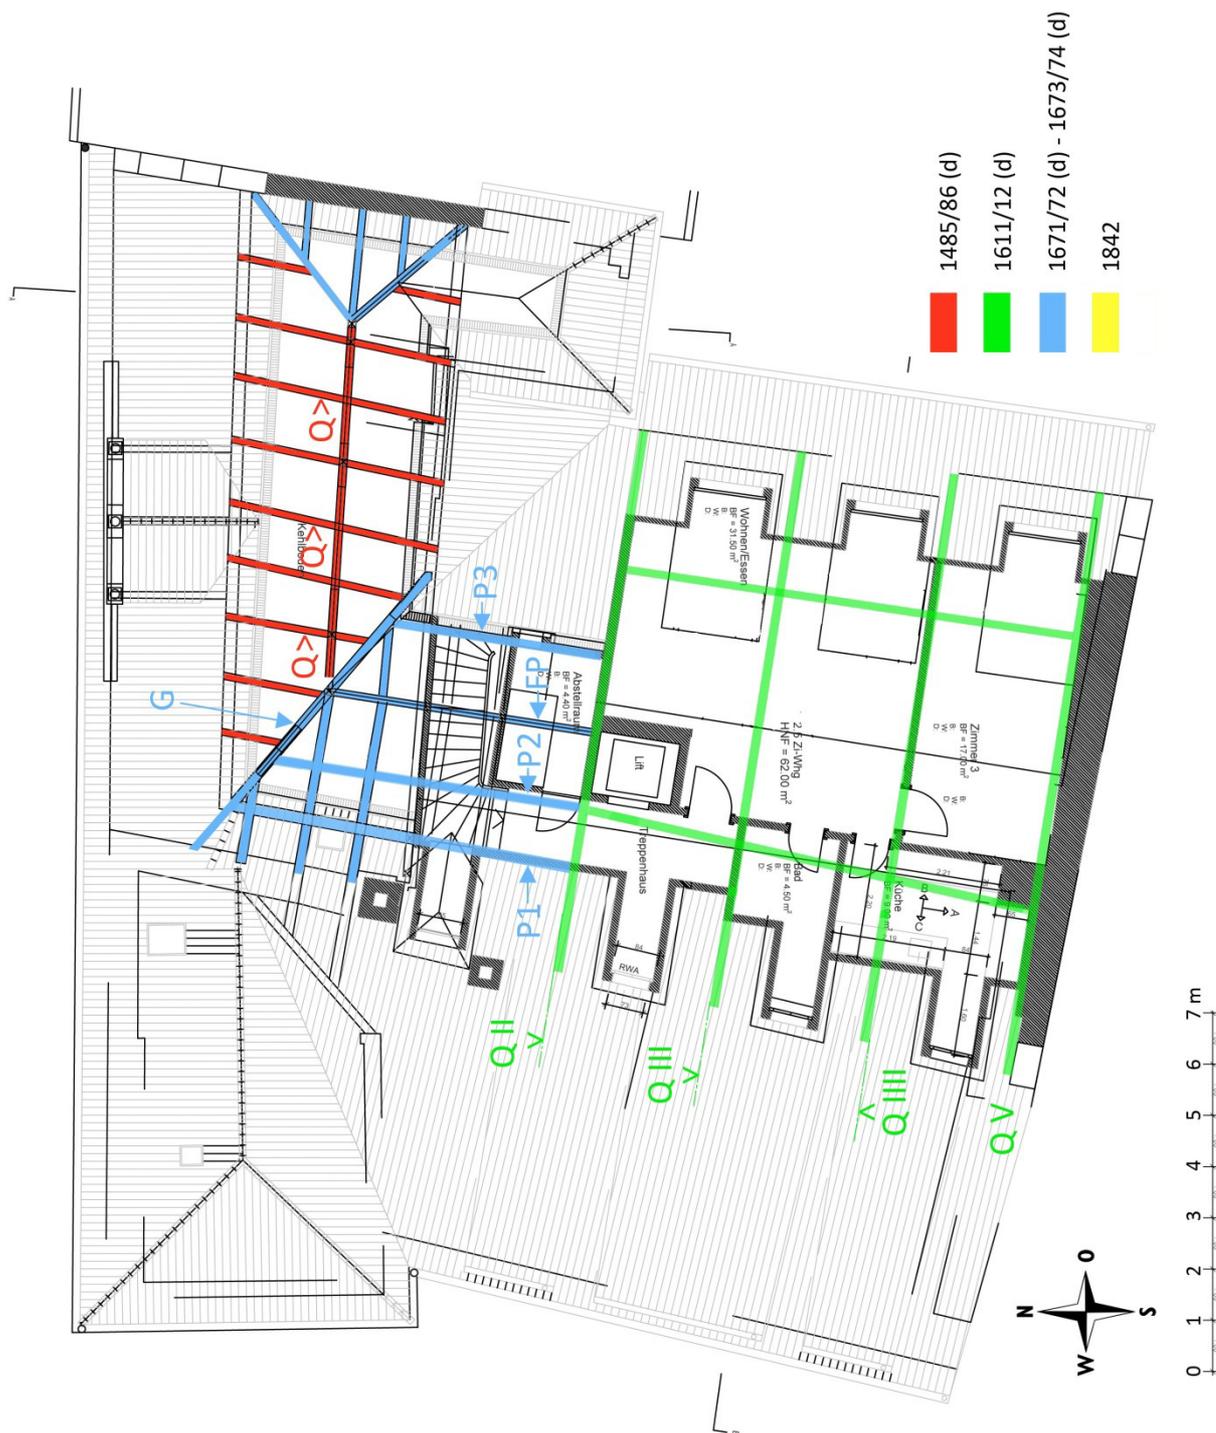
Korporationsgebäude. Grundriss 2. Dachgeschoss (Nordhaus) und 1. Dachgeschoss (Südhaus).
